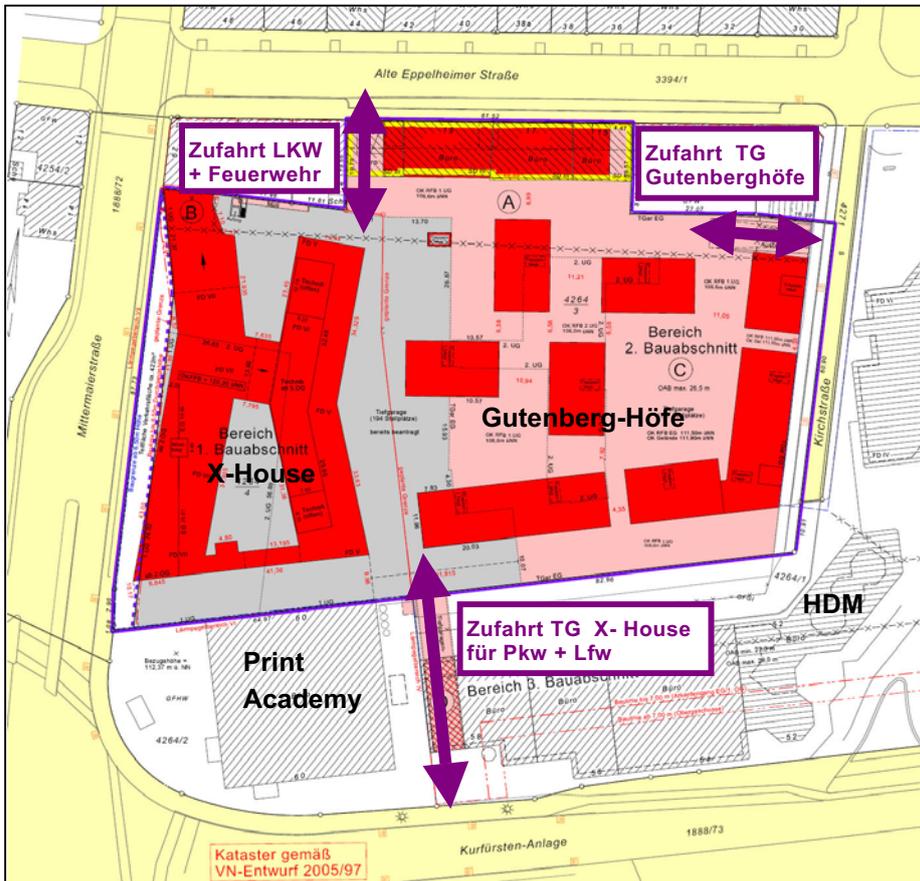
Bauvorhaben „X-House“ und „Gutenberghöfe“ mit geplanter Erschließung (Ausschnitt aus: Übersichtsplan, Vermessungsbüro Butsch; mit eigenen Ergänzungen)
